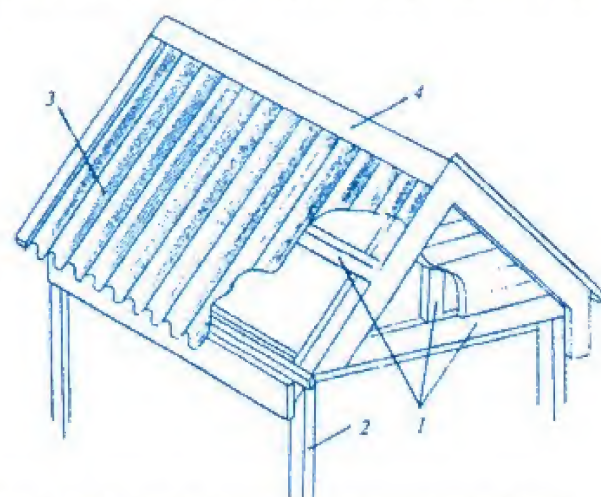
Конструкція двосхилого даху альтанки: 1 — несучі дерев'яні конструкції; 2 — опорний стояк; 3 — покрівельний матеріал (листи шиферу); 4 — гребінь
